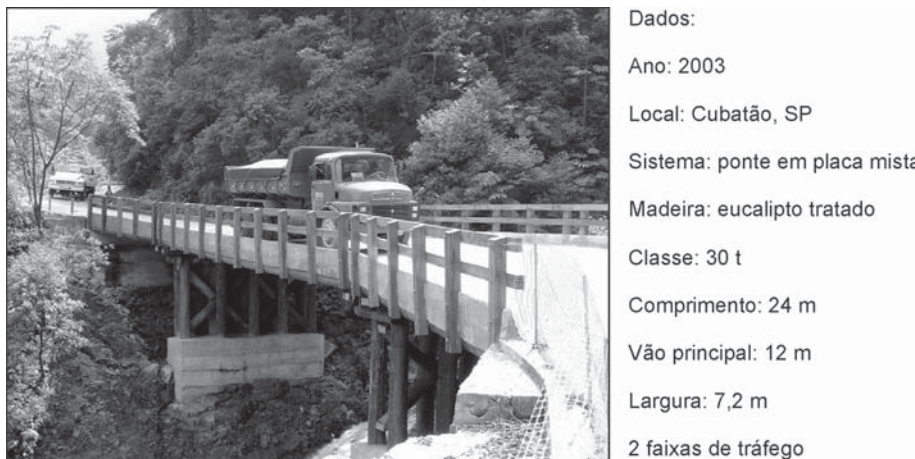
Ponte em placa mista madeira–concreto (Ponte Caminho do Mar).
